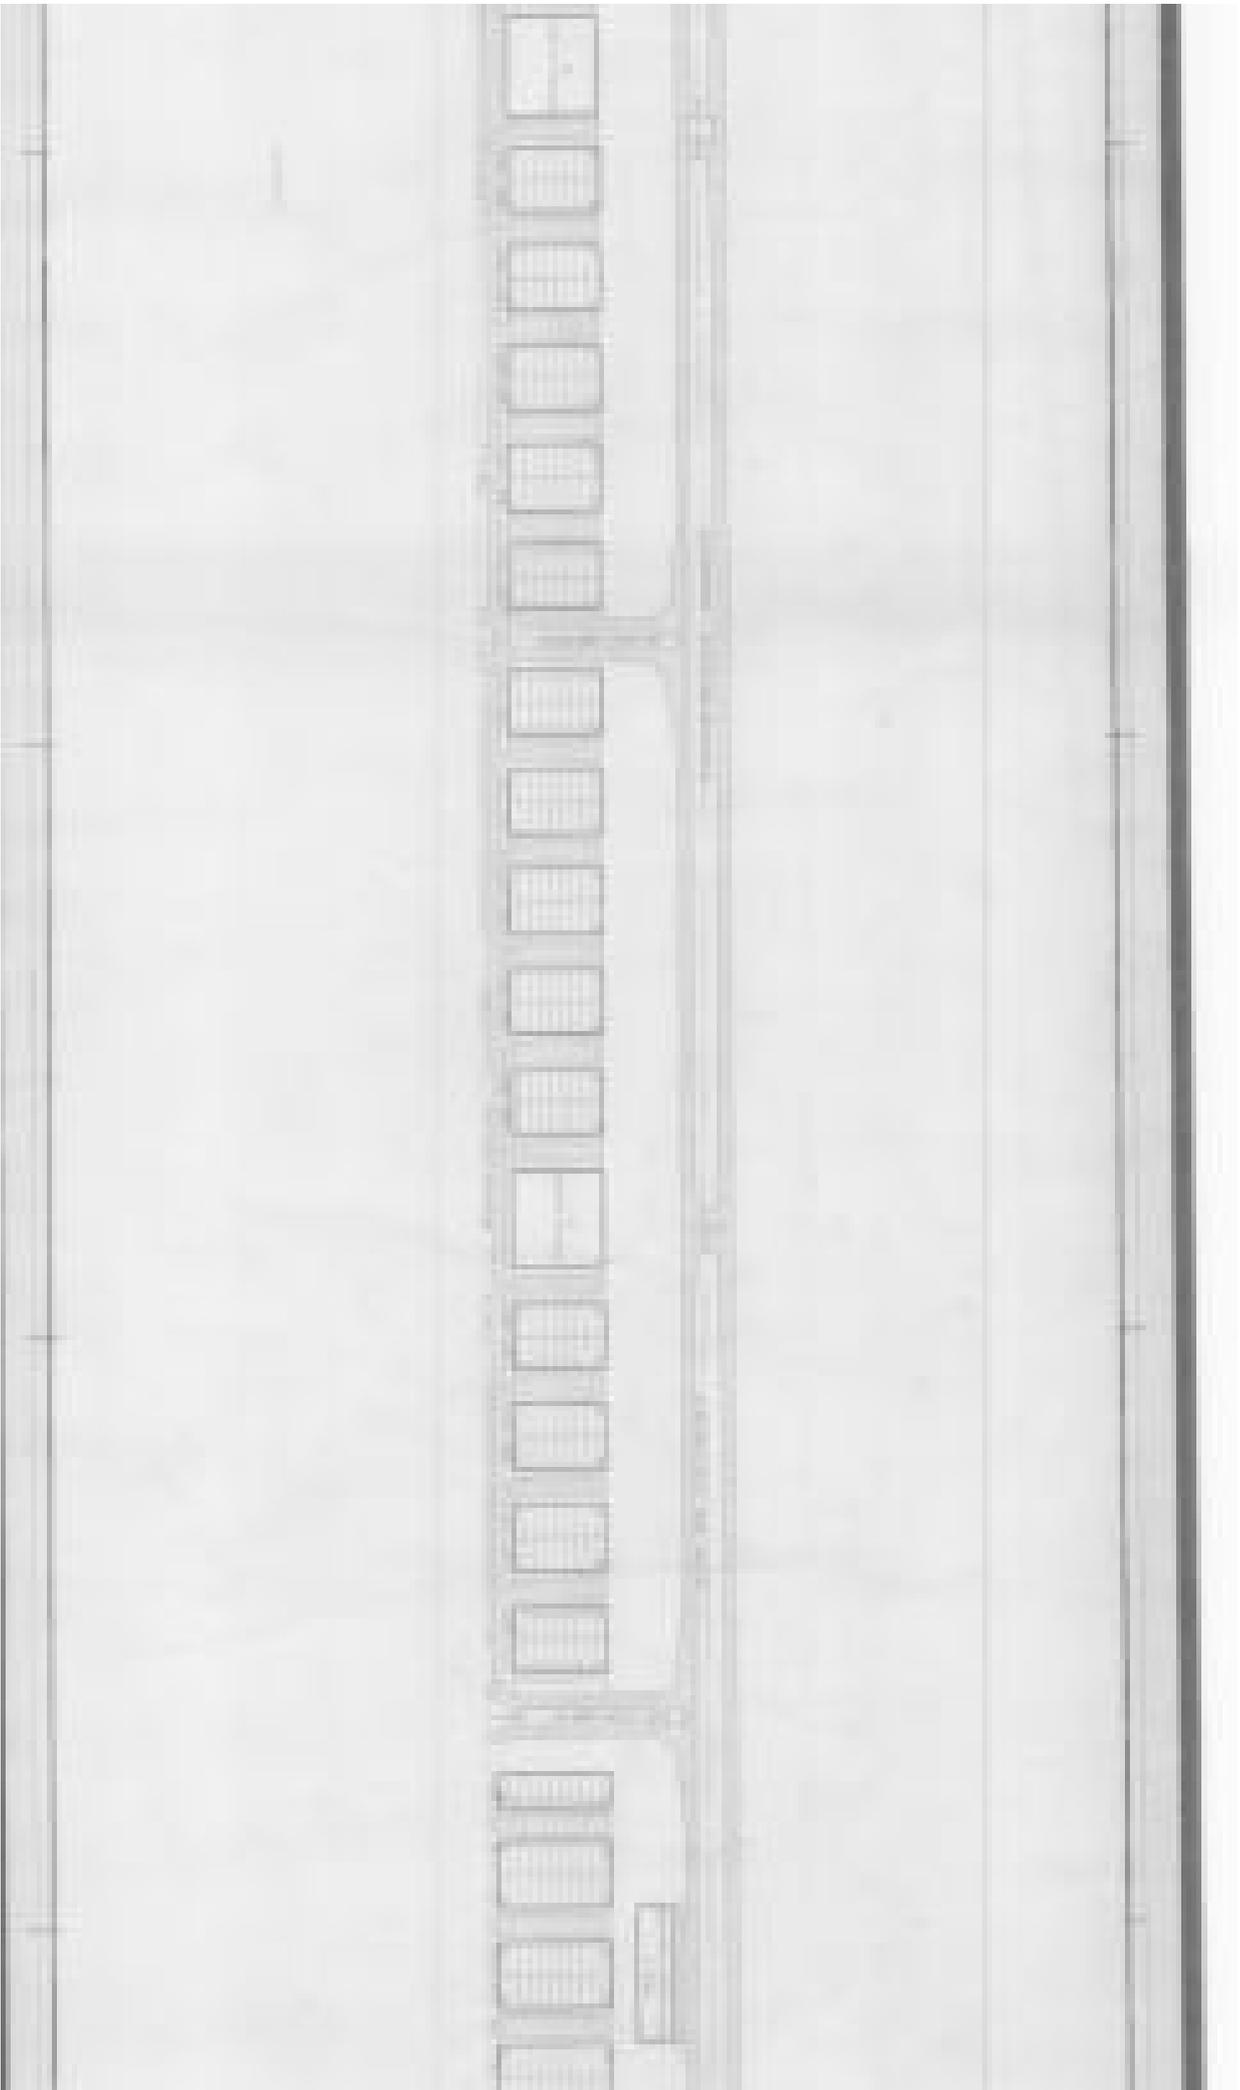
PR 56/1 - Planta Geral - Praça Central Núcleo Bandeirante
